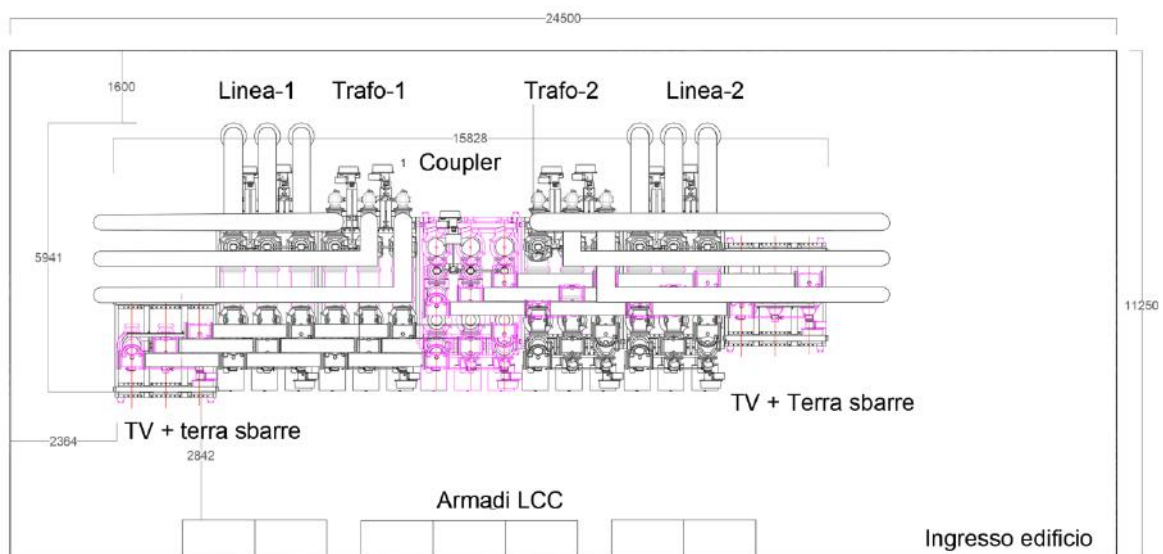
Planimetria del locale magazzino, con lay-out preliminare di inserimento del GIS 220 kV
